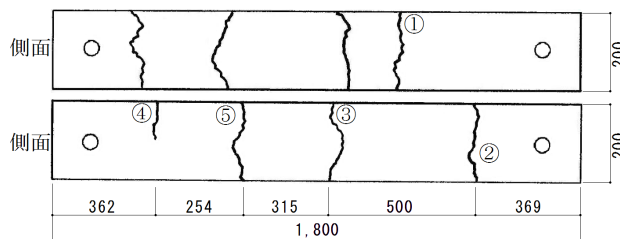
(c) ひび割れ状況 ガラス繊維(3-1)
